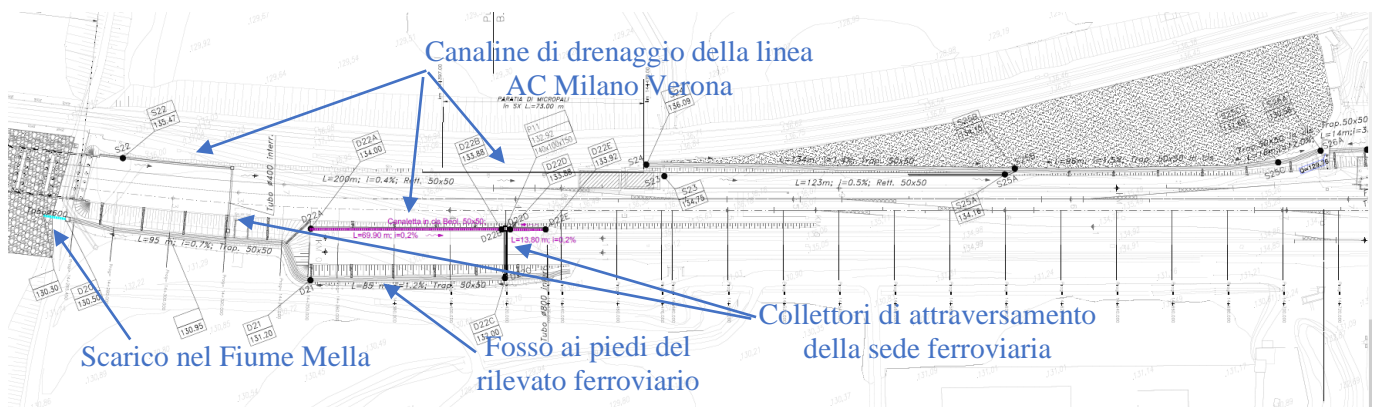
Sistema di drenaggio esistente Area Asta 350m – Fonte: IN01-01-C-ZZ-P8-RI3703-001_B: RI37 - Rilevato dal km 14+265,45 al km 14+734,71 – Planimetria idraulica
